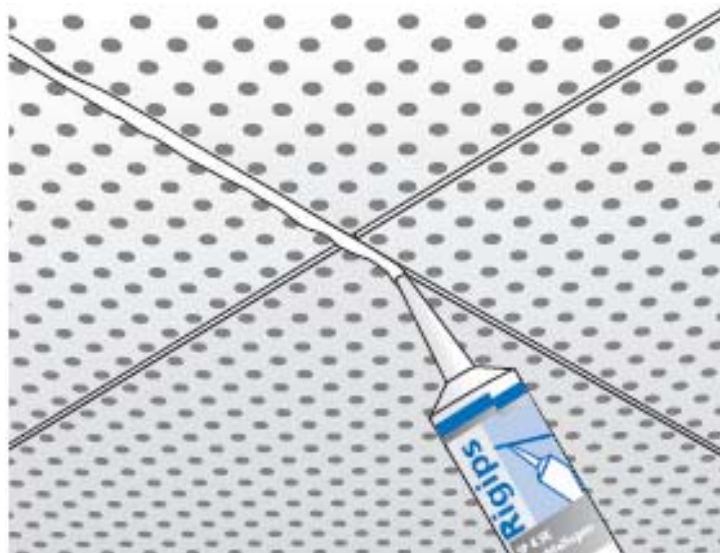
Rigitone™ - Remplissage des joints au pistolet extrudeur
